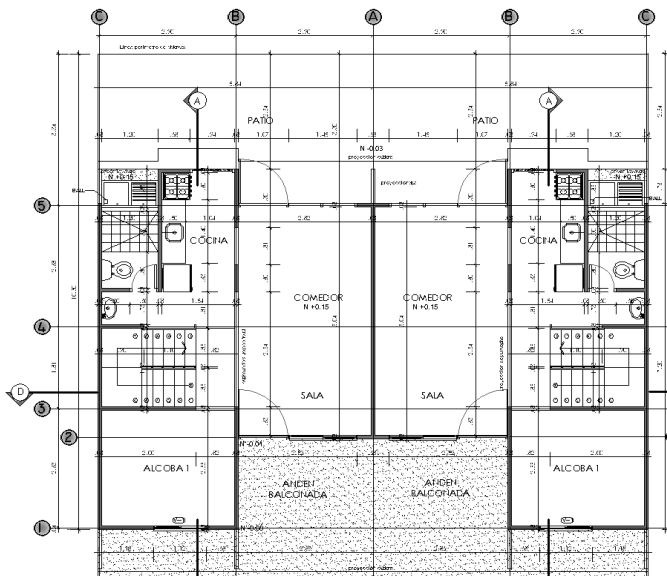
planta arquitectónica piso 1 (muros prefabricados-CC).
